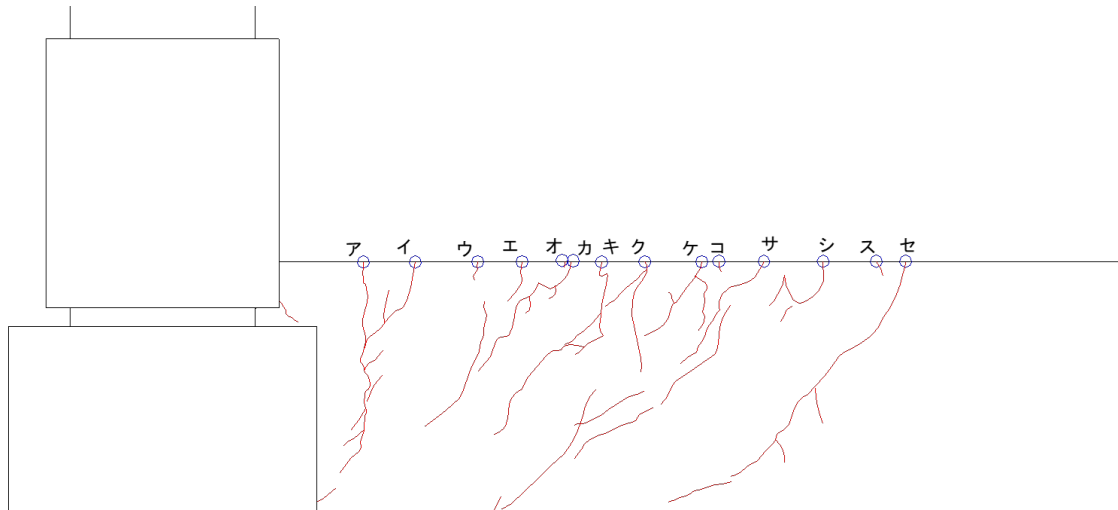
基礎梁ひび割れ幅測定位置(試験体 A-2 負荷荷)
